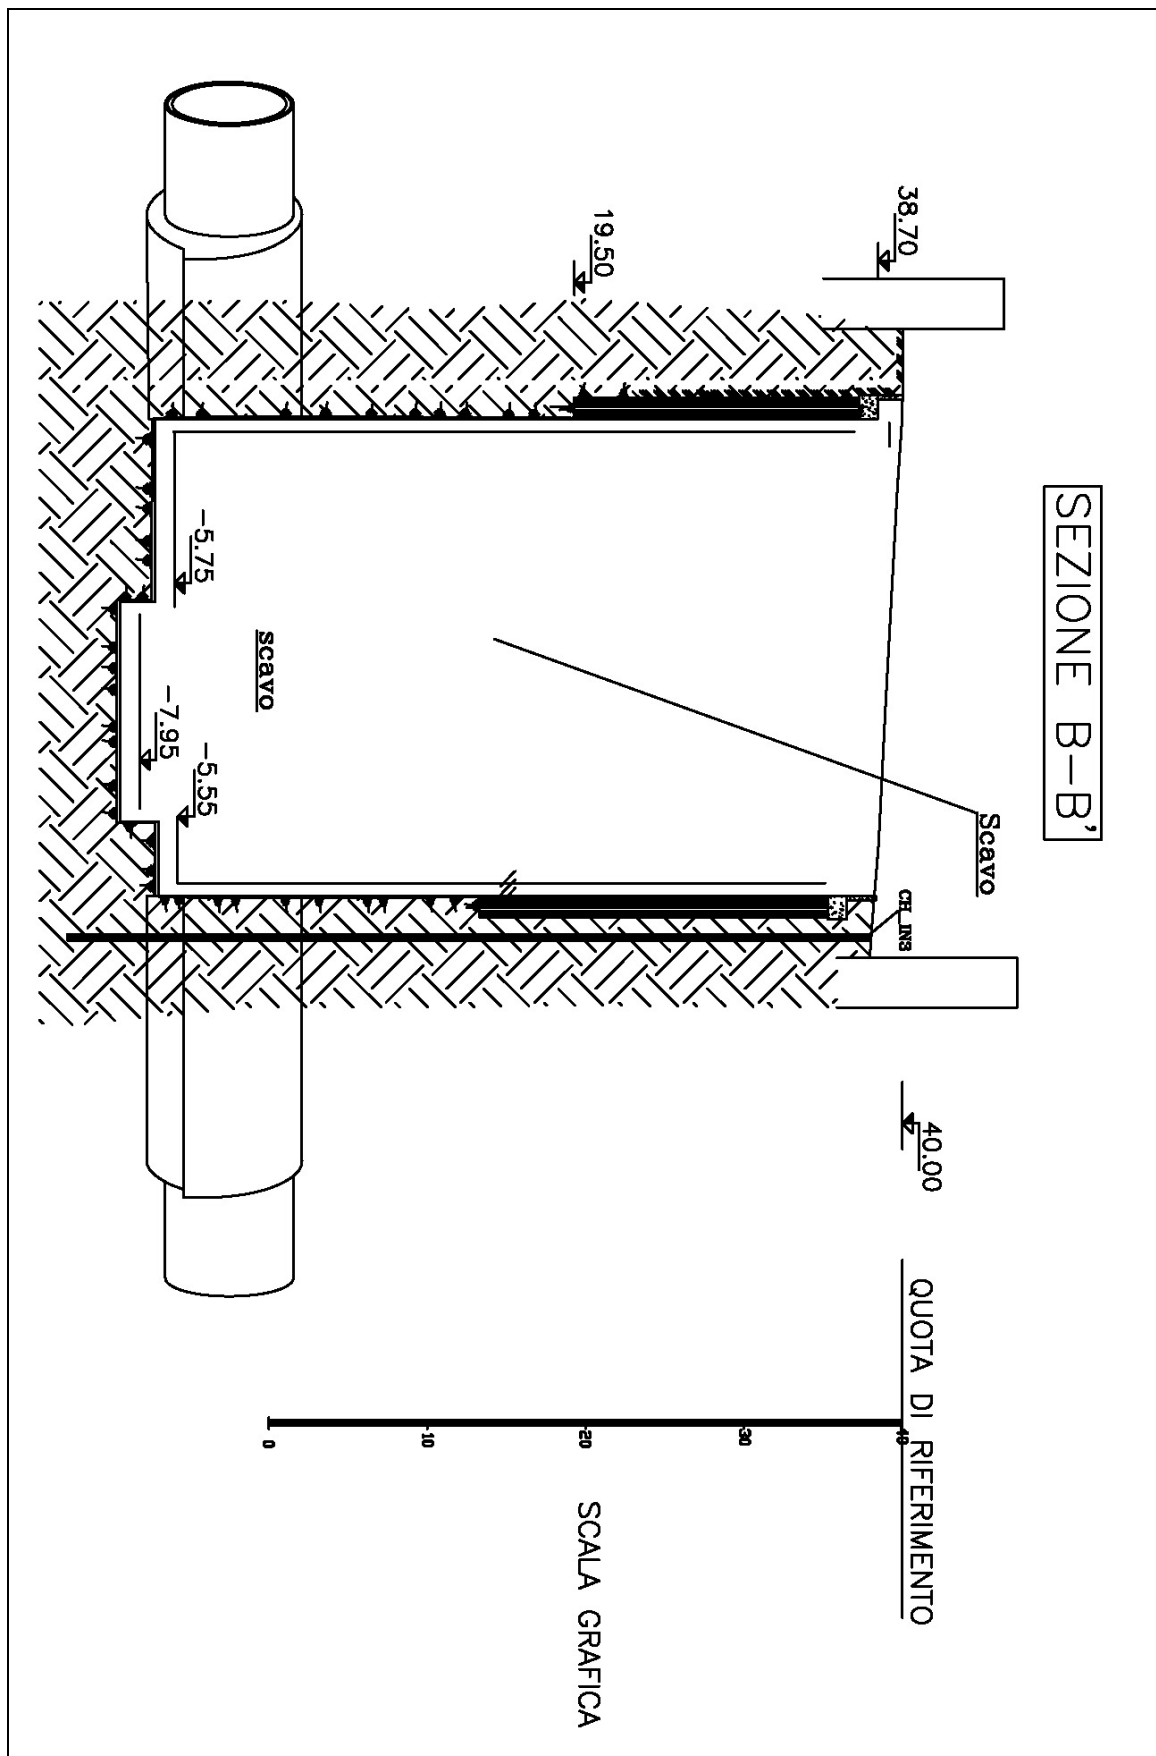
Sezione B-B' pozzo stazione, raffigurante la suddivisione in aree di lavoro.
